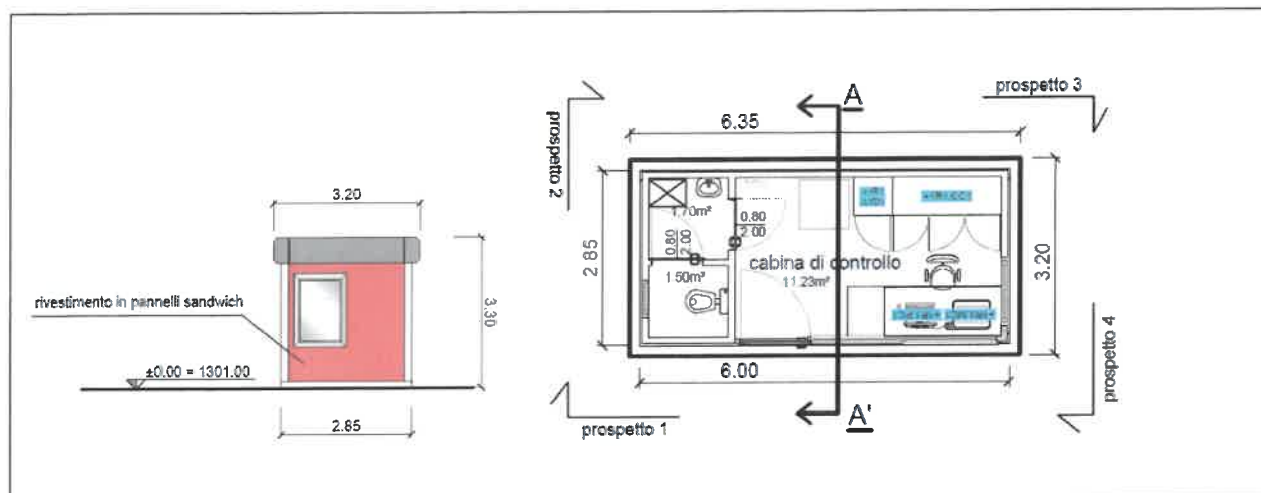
Cabina di controllo (valle) pianta e prospetto (Elaborato EG13)
